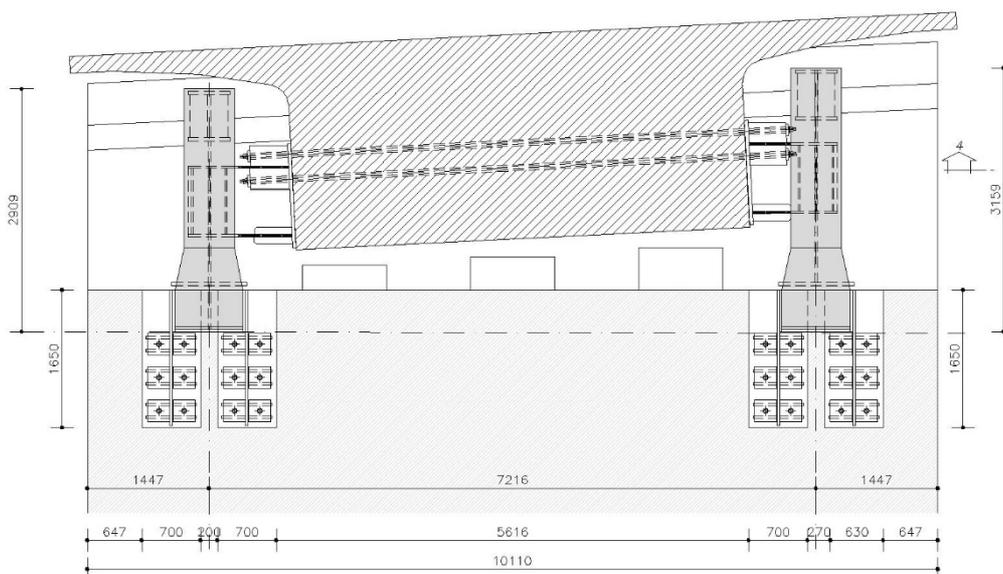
Spalle Sp.2 e Sp.4 - Prospetto frontale
